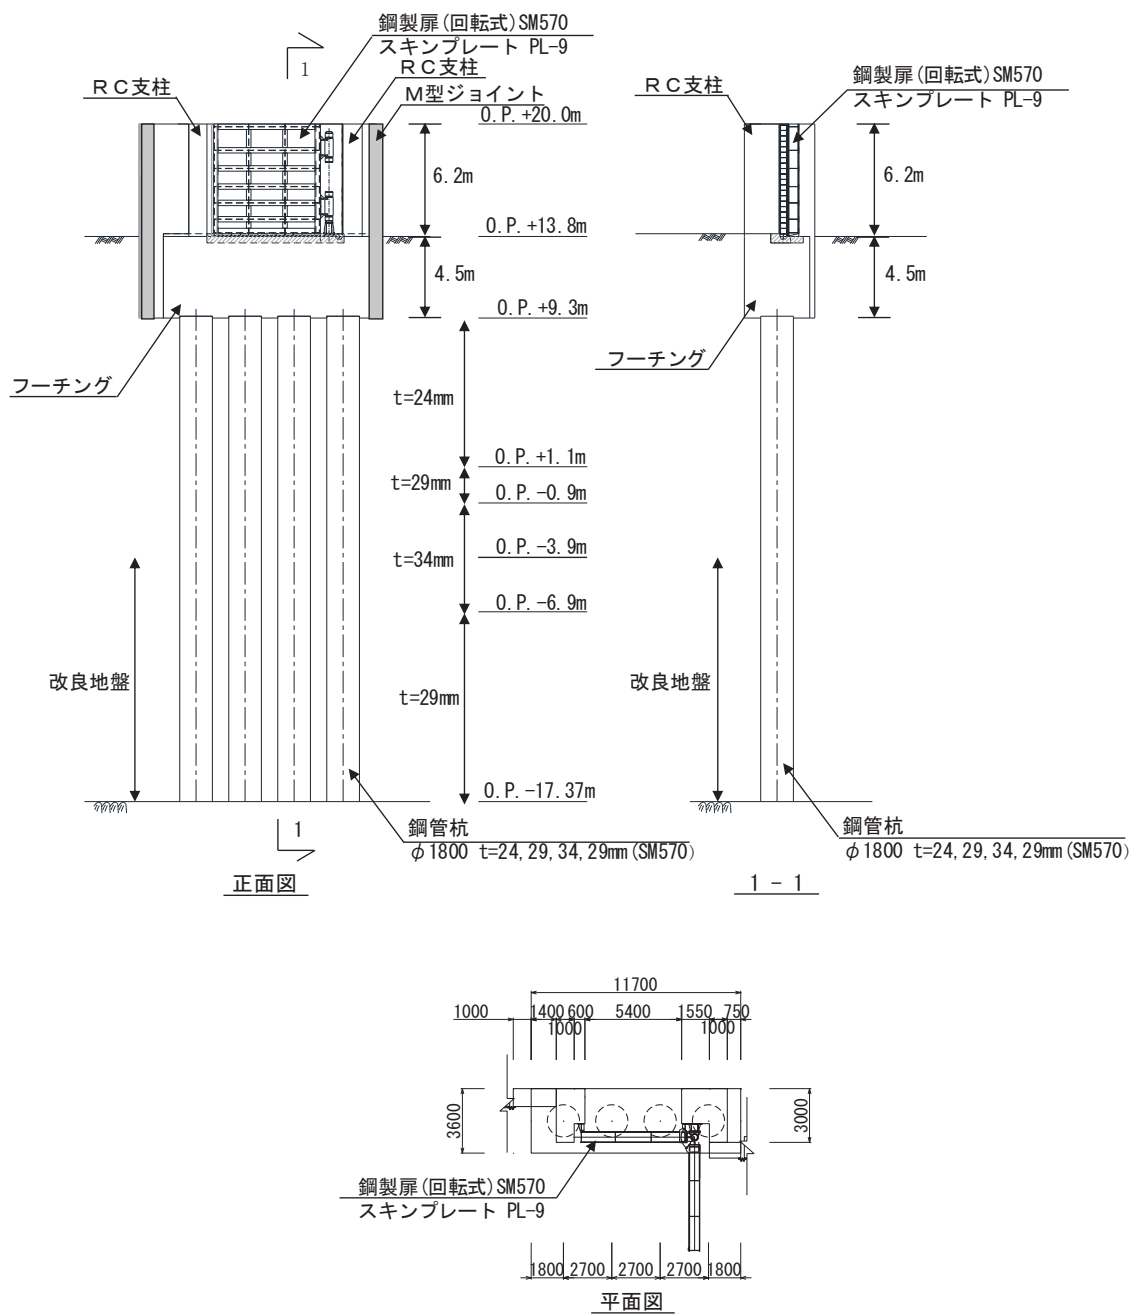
鋼製扉 3 の構造図 (正面図及び断面図, 平面図)
